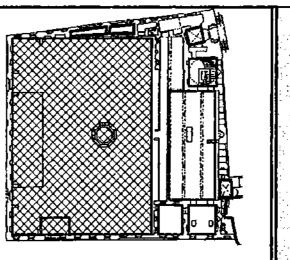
مسقط أفقي مدرسة المؤيد شيخ [188:161]
